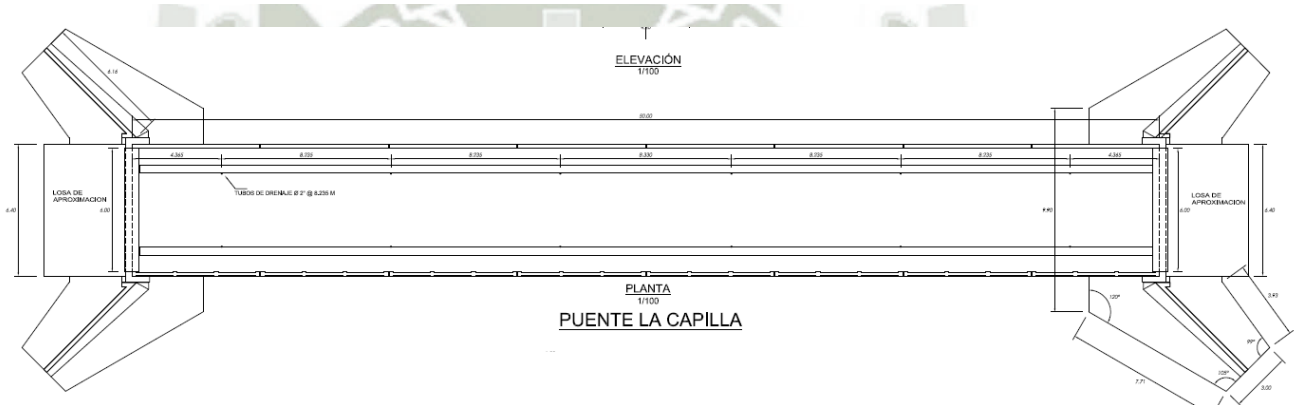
Estribo de apoyo extremo y superestructura viga losa.
